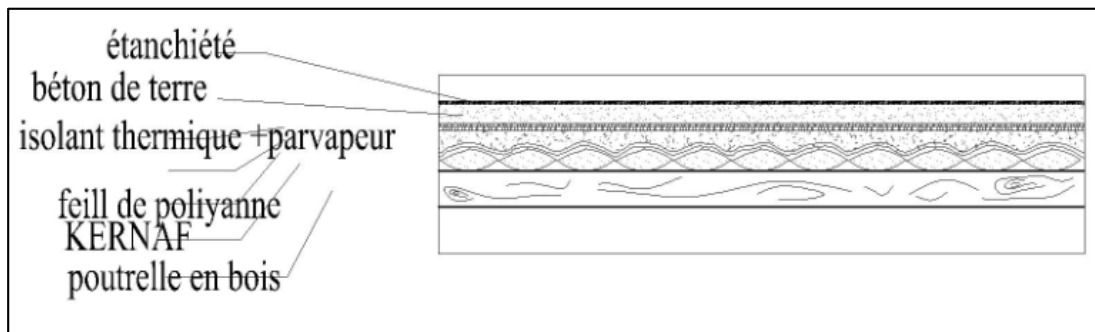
Détail de plancher à Kernaf (Source : auteur)
